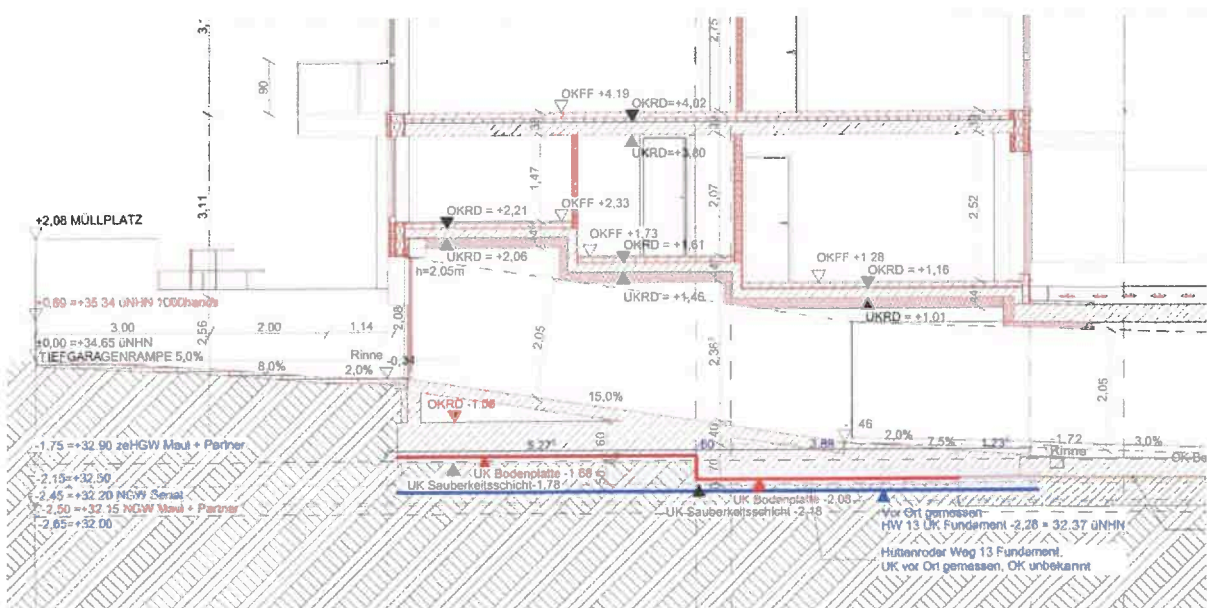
Geländeschnitt mit blau eingezeichneter Bodenplatte
